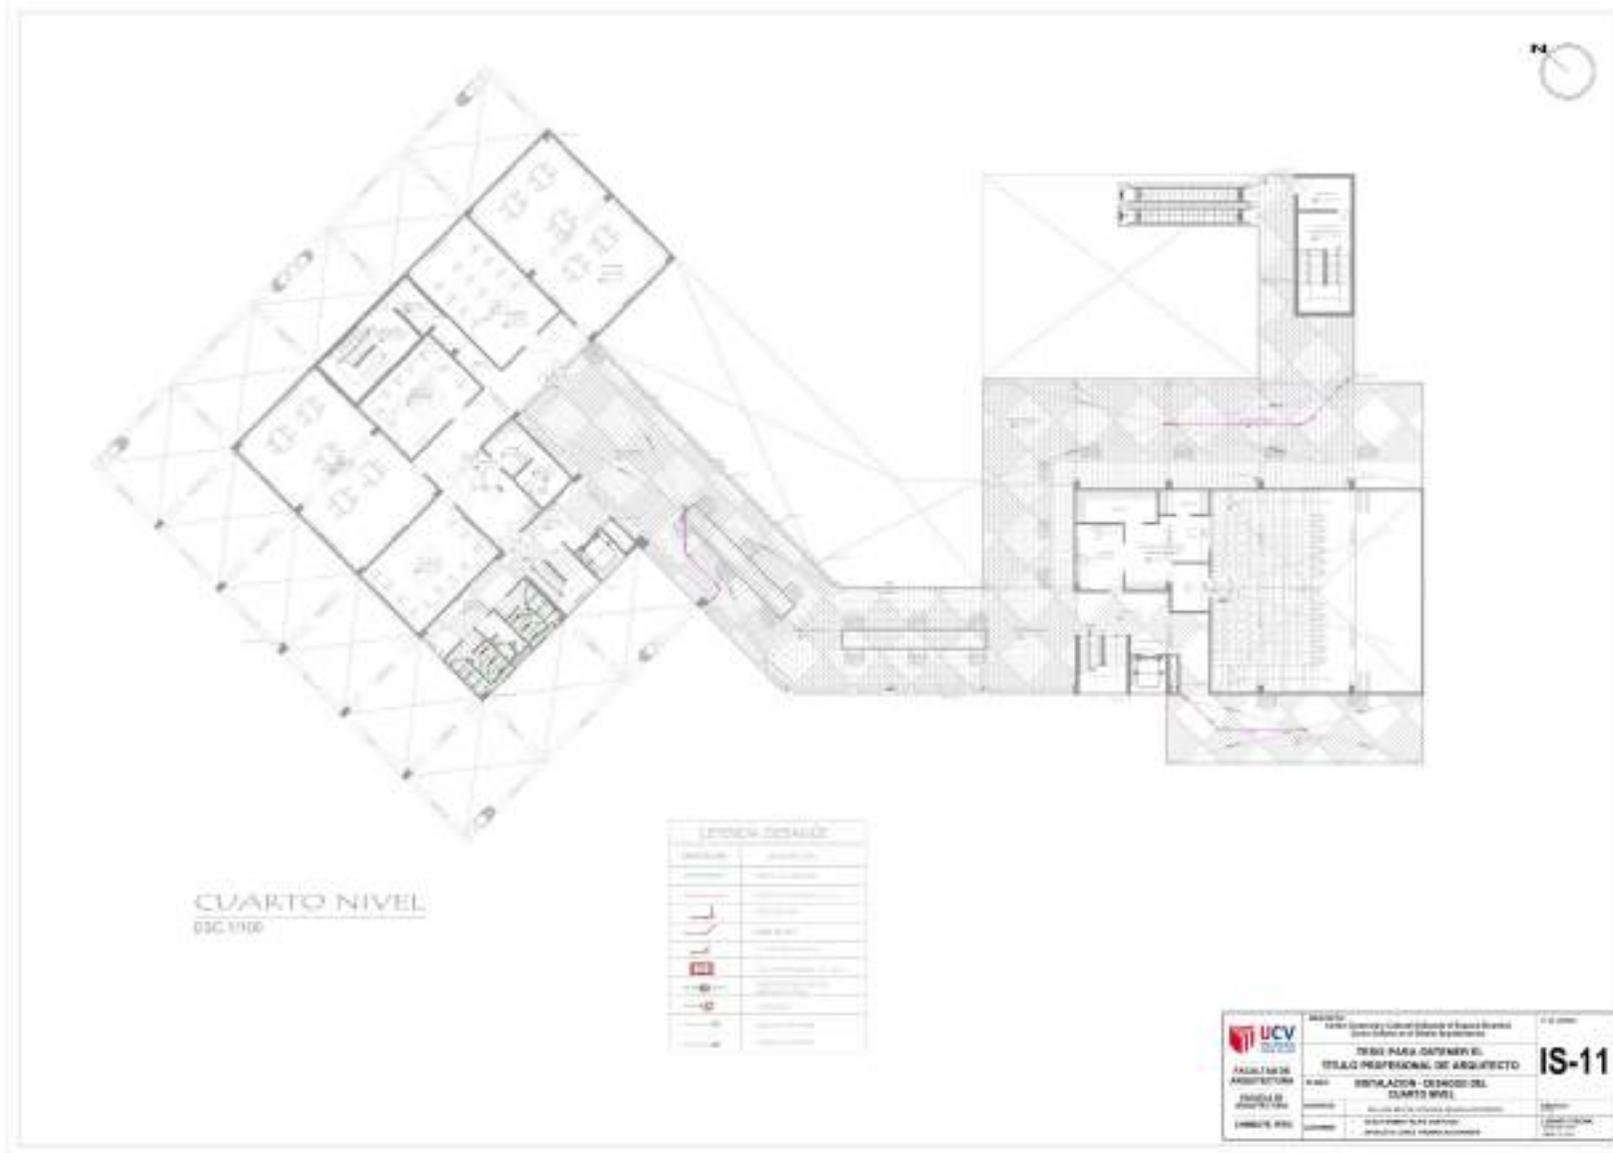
Plano de instalación de desagüe y pluvial cuarto piso
